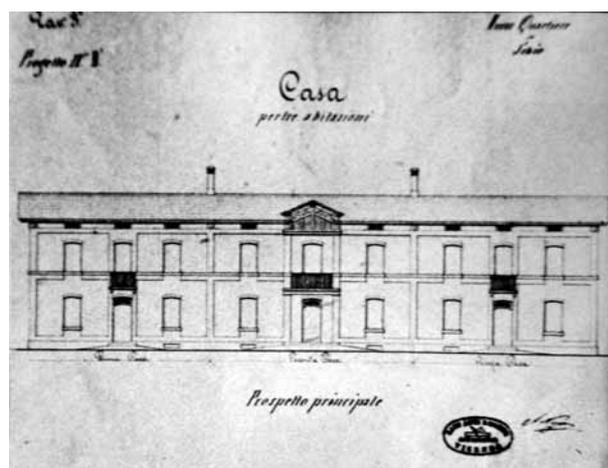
Fachada de casa tripla do Lanerossi. Projeto Antonio Caregato Negrin.
